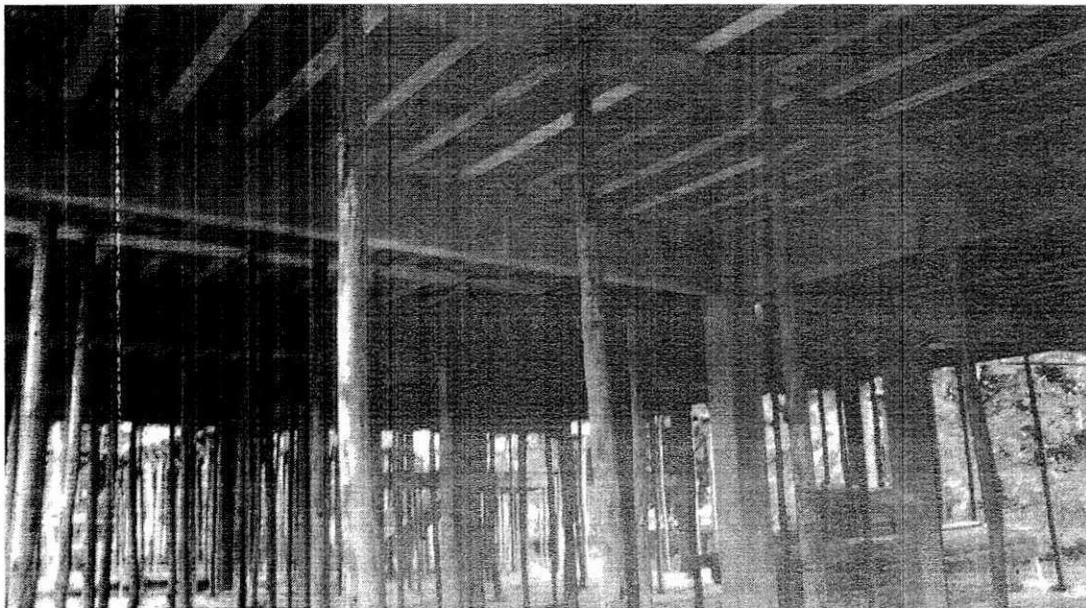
Detalhe do forro de laje pré fabricada da obra SIASS.
